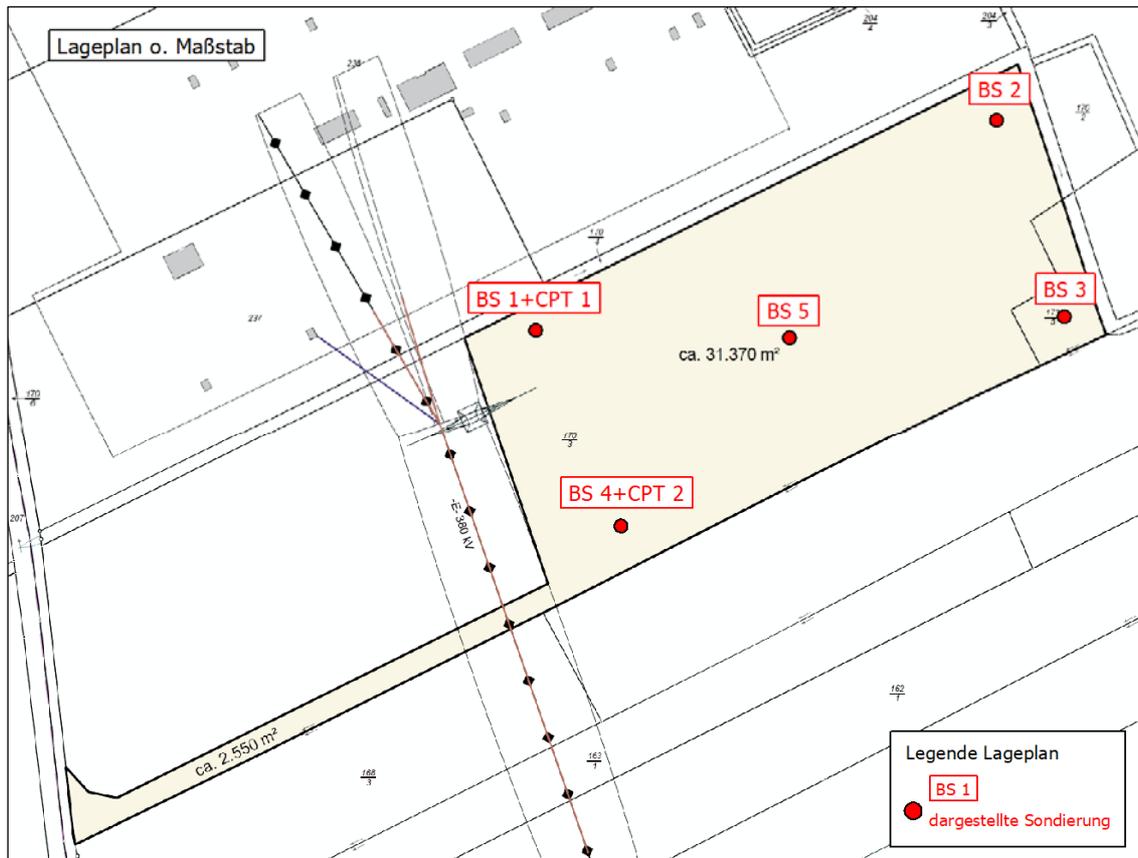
Auszug aus Anl. 1.1, Lageplan (o. M.)
